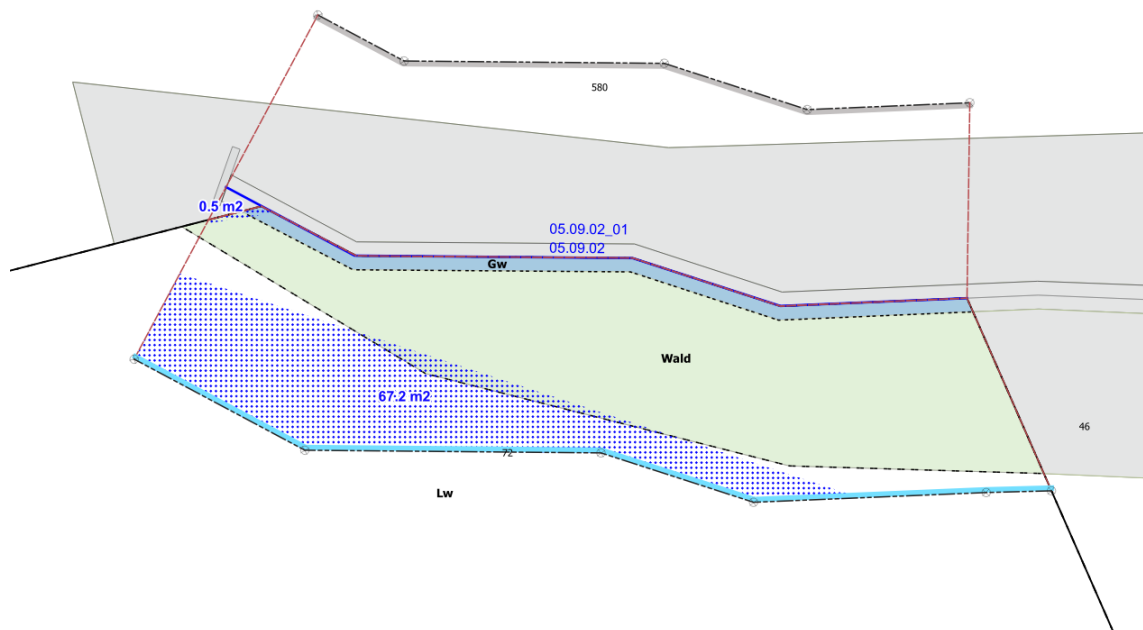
Fruchtfolgefläche innerhalb des Gewässerraums im Abschnitt 05.09.02_01
